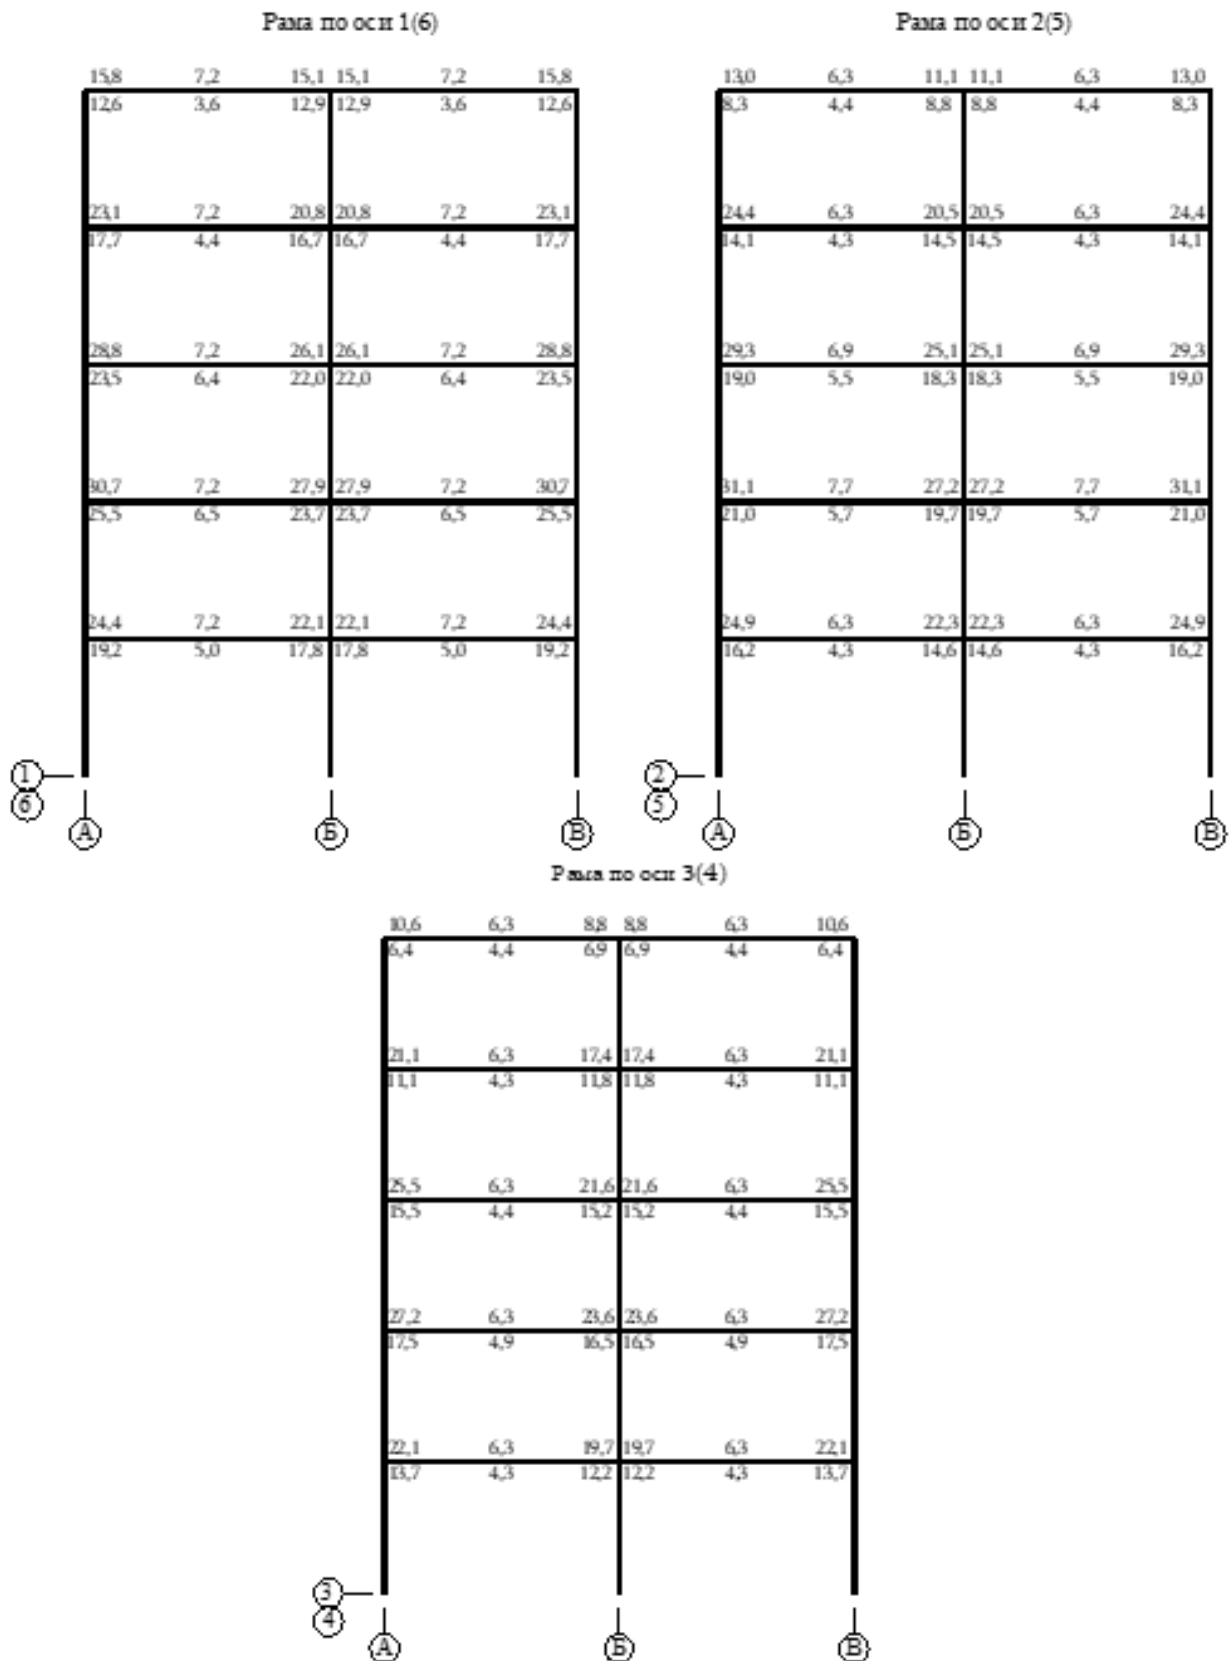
Продольное армирование балок поперечных рам, требуемое по расчету (см²)
